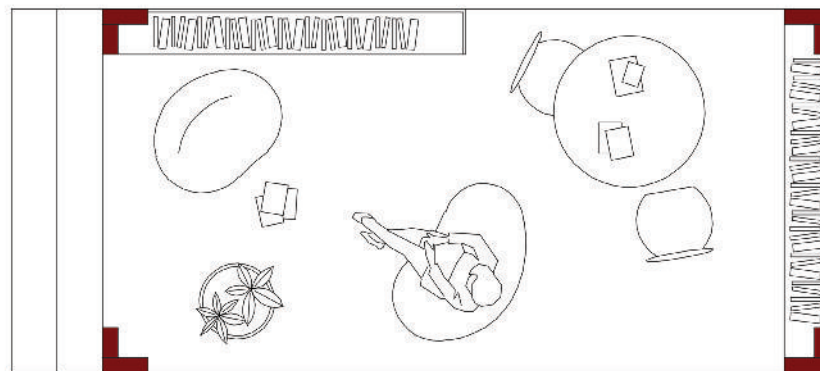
\_ Spazio lettura \_ Planimetria \_ Scala 1:50
